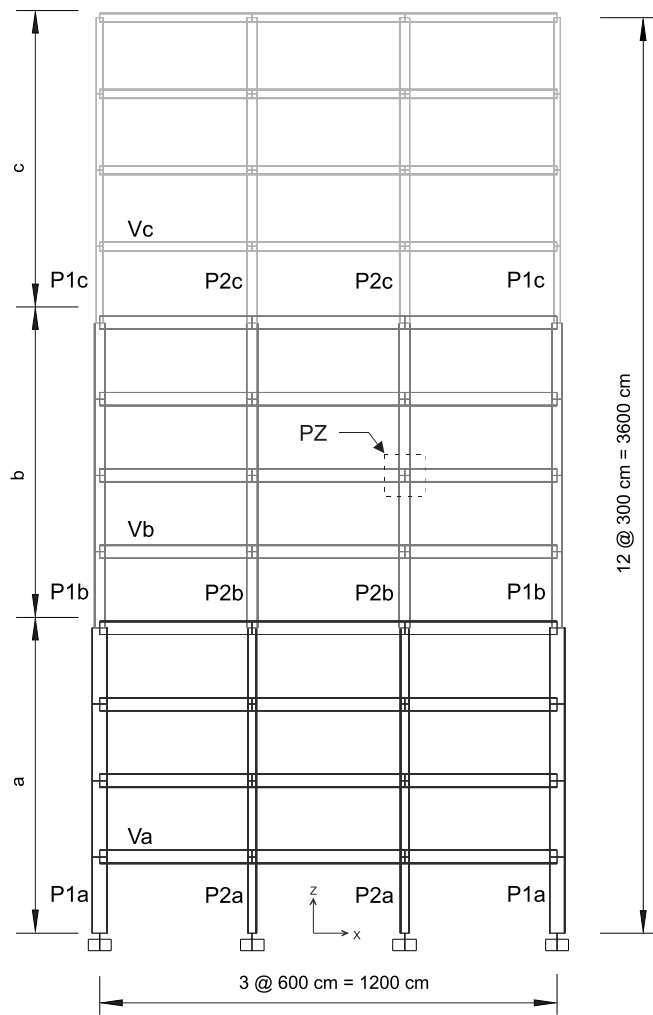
Caso 1 – Pórtico rígido de 12 pavimentos.
